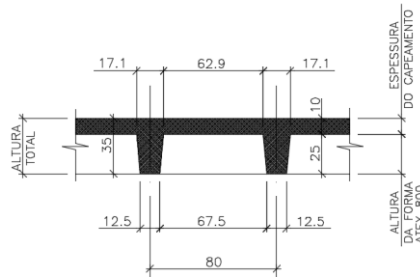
Corte da seção transversal da laje nervurada – cotas em cm
